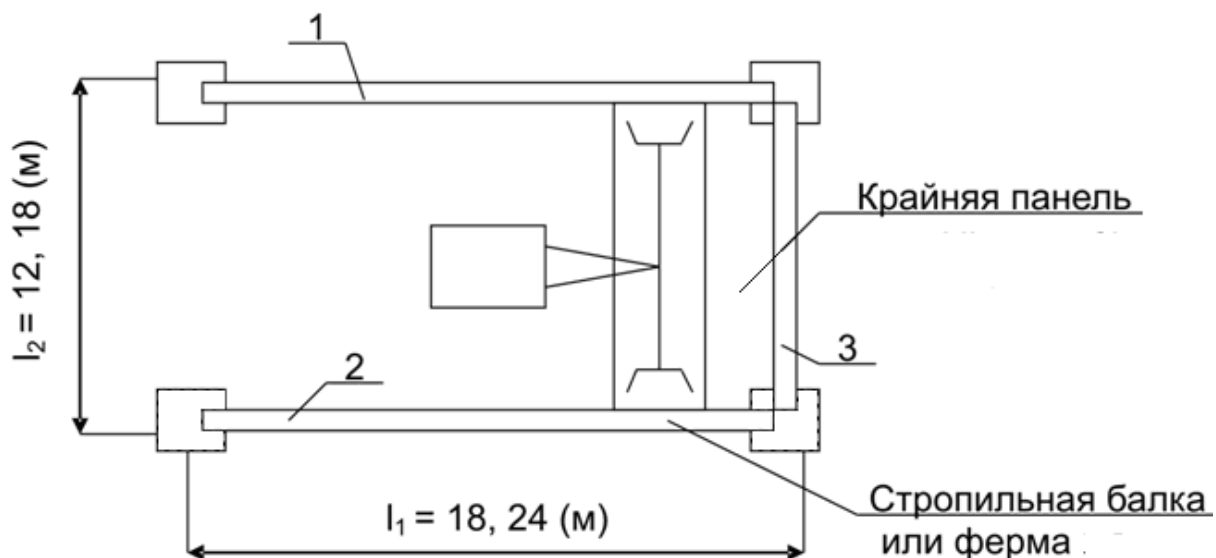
Монтаж длинной оболочки: 1, 2, 3 – порядок монтажа контурных элементов
